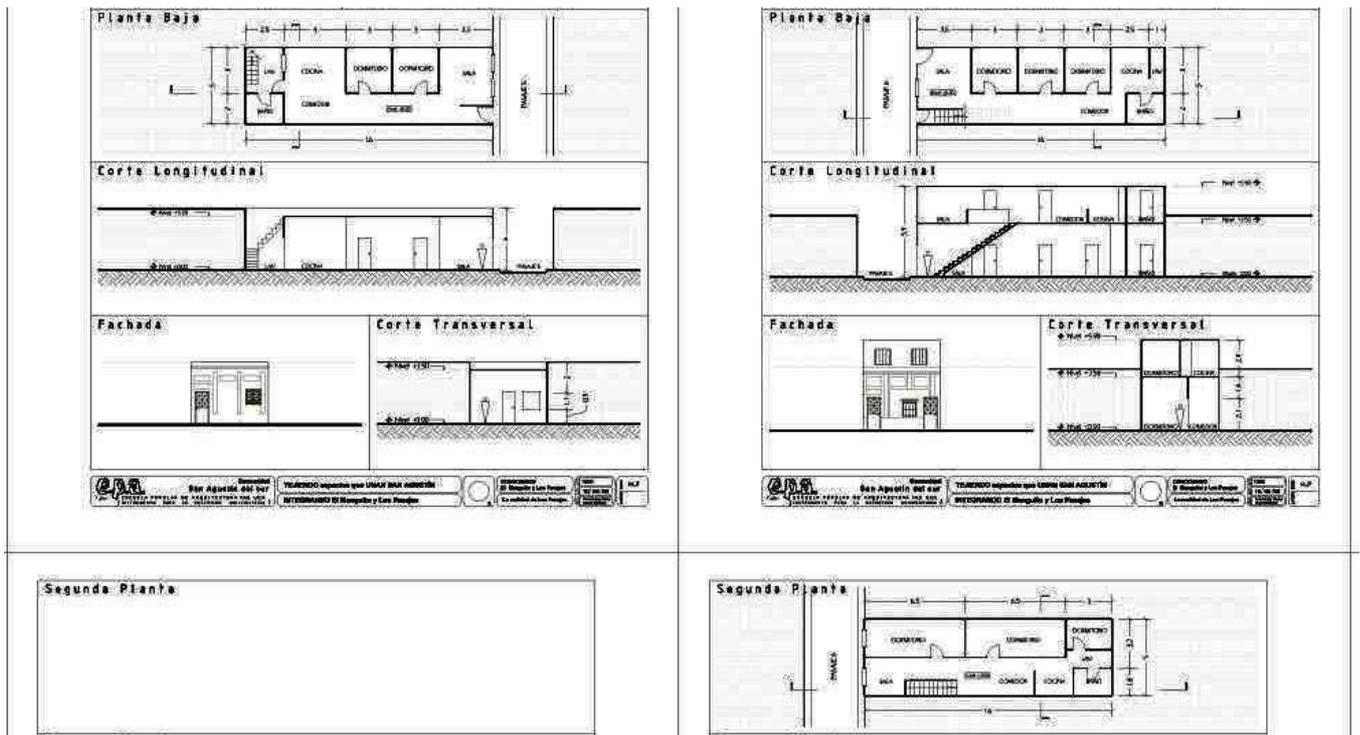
Intervenciones de viviendas en los Pasajes. 2006.
